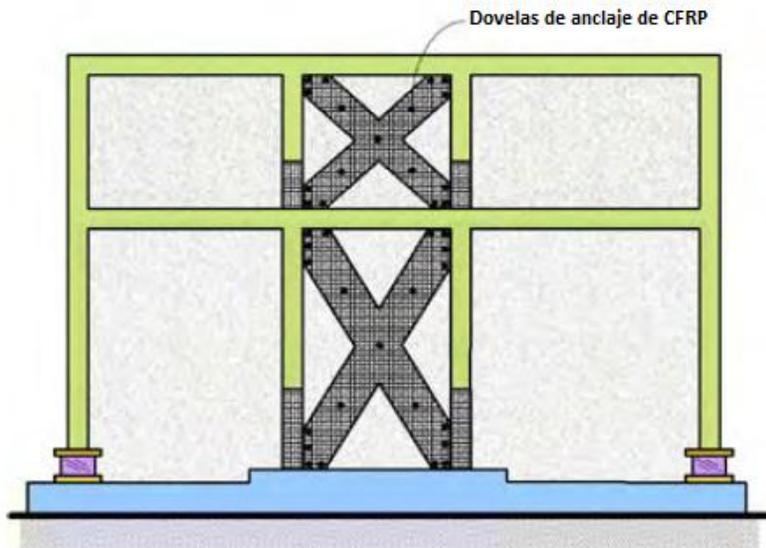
Configuración de tiras de CFRP y ubicación de dovelas de anclaje (fuente: C.V.R. Murty, adaptado de Erdem et al. 2004).
